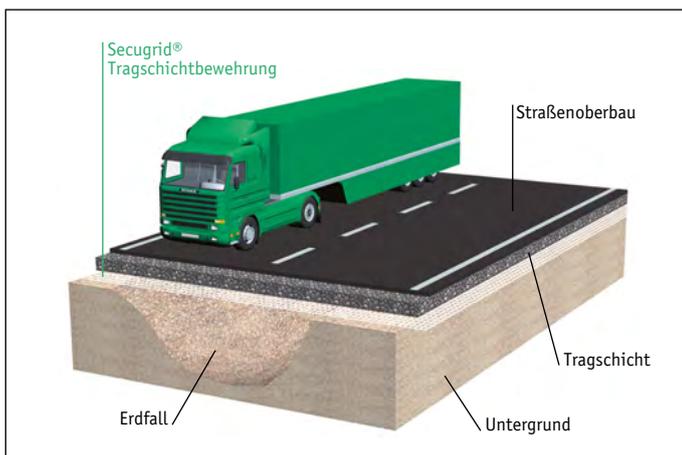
Tragschichtbewehrung über Erdfallgebieten
